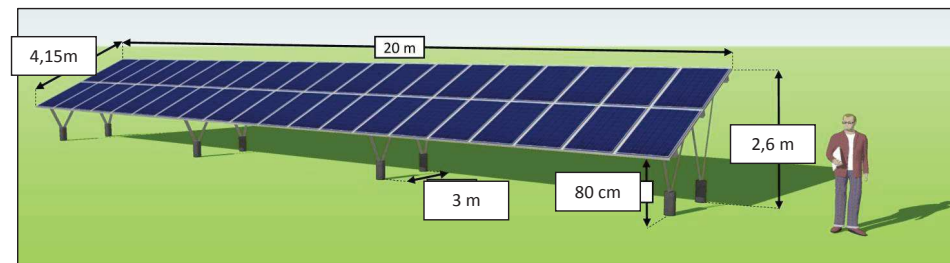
Illustration 3D d'une structure support (exemple sur pieux battus)
